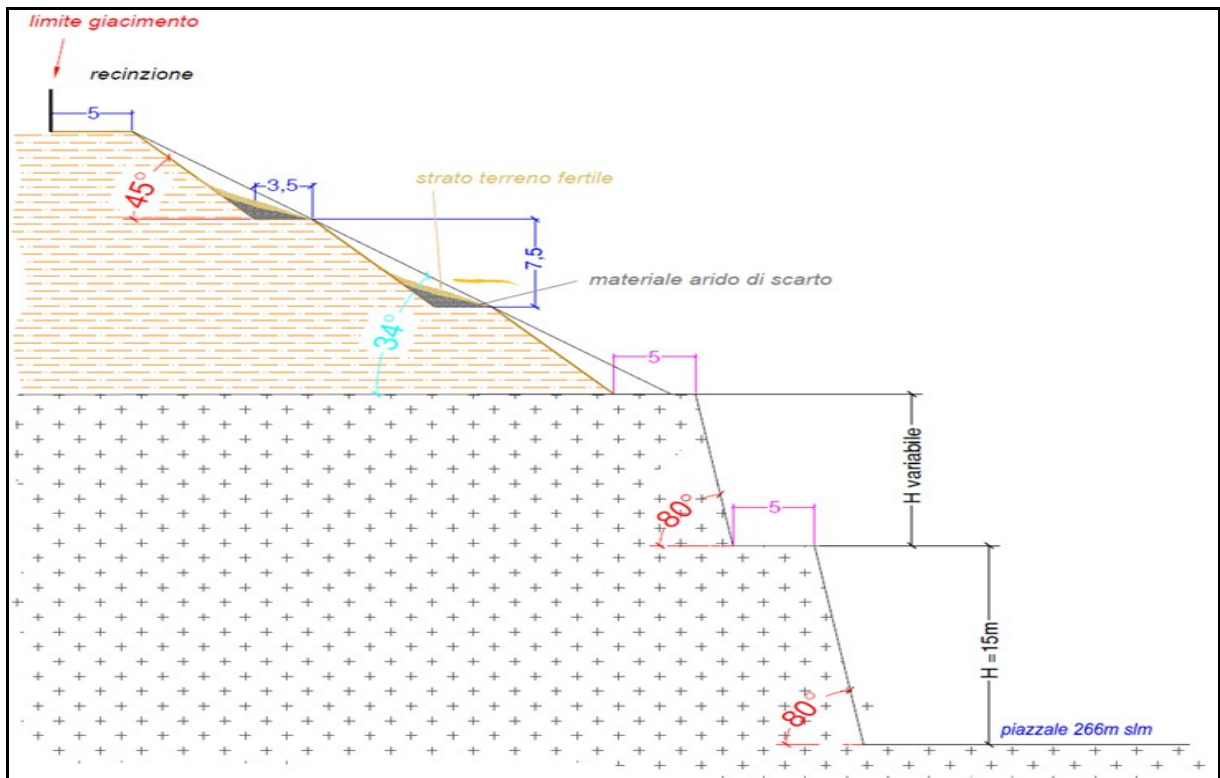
stralcio Tav.17 progetto Preliminare – sezione tipo di coltivazione
